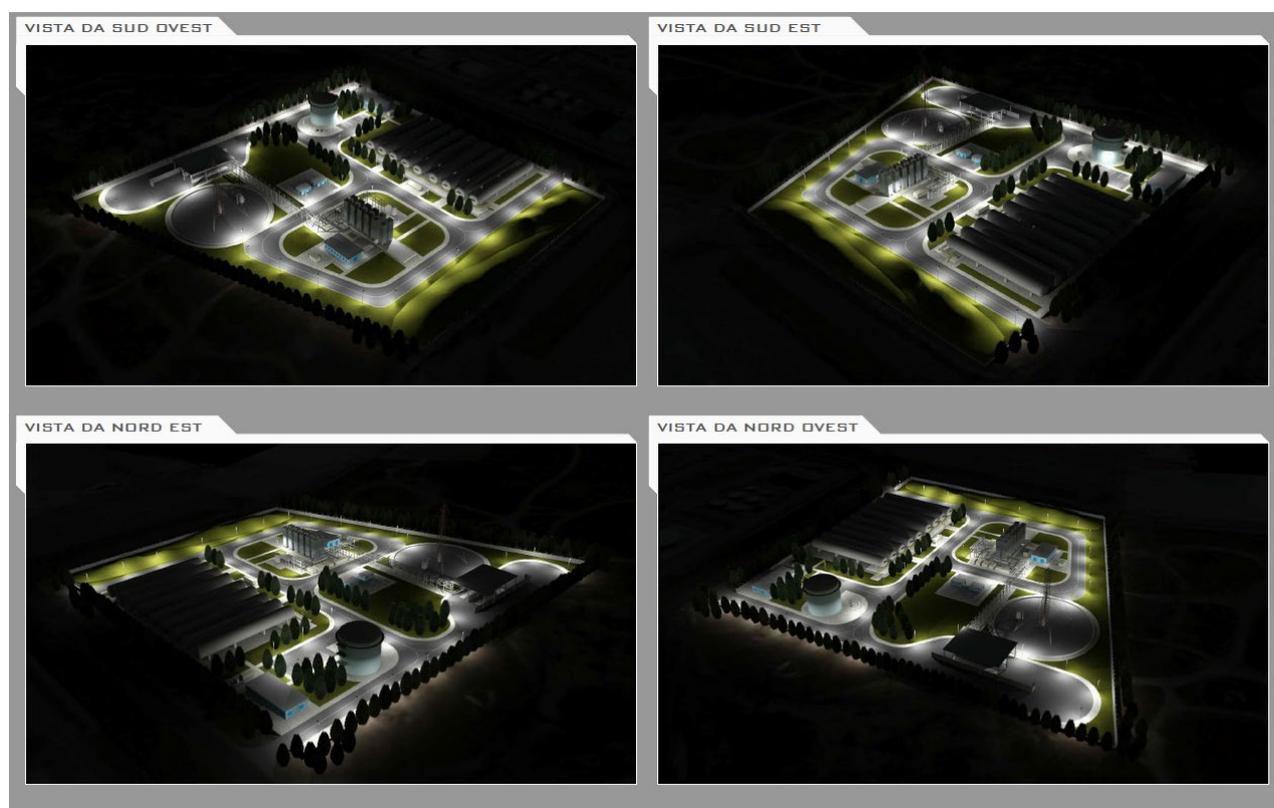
b: Progetto Impianto Illuminazione Esterna, Viste Prospettiche Notturne
